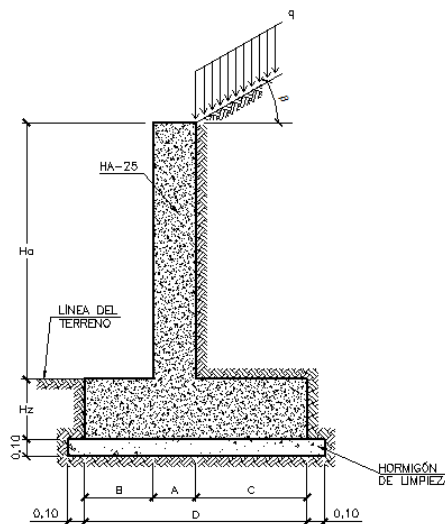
Dimensiones de muro tipo de hormigón armado. Fuente: Elaboración propia.
